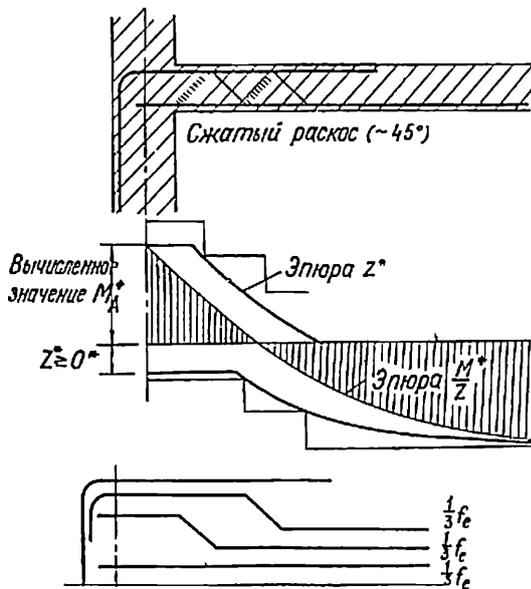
4. При сильном защемлении арматура, работающая в зоне защемления, заводится в тело стены. При стержневом армировании отогнутые стержни на двух участках являются целесообразными
